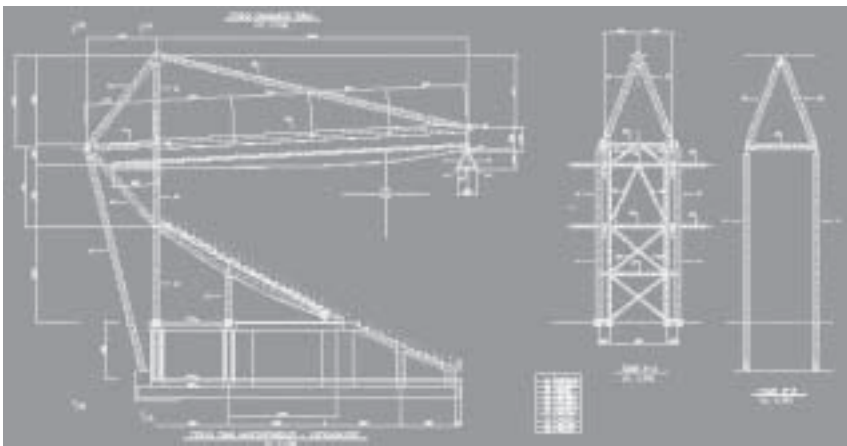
Vista in pianta delle strutture di copertura e sezione trasversale delle tribune
